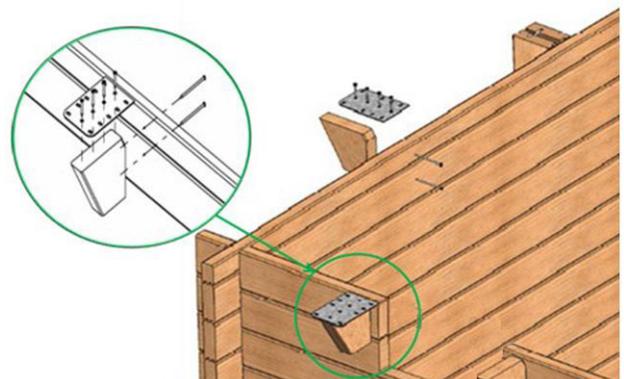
Installation der Metallplatten auf den Konsolen des Handlaufs
